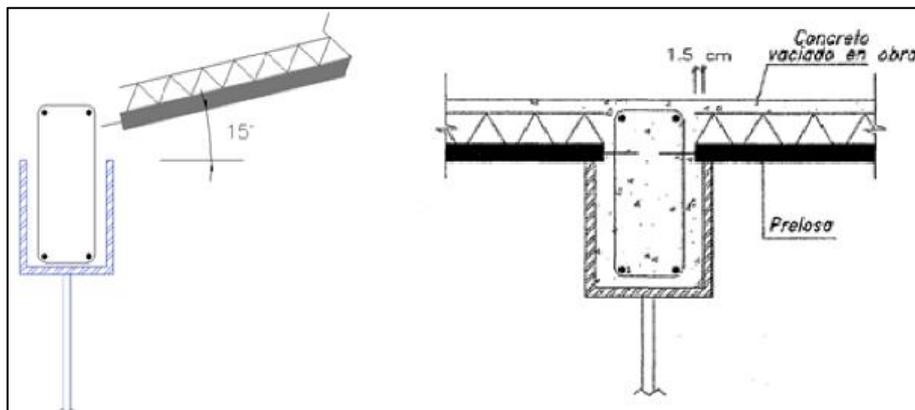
Apoyo de prelosa prefabricada sobre encofrado de fondo de viga.
